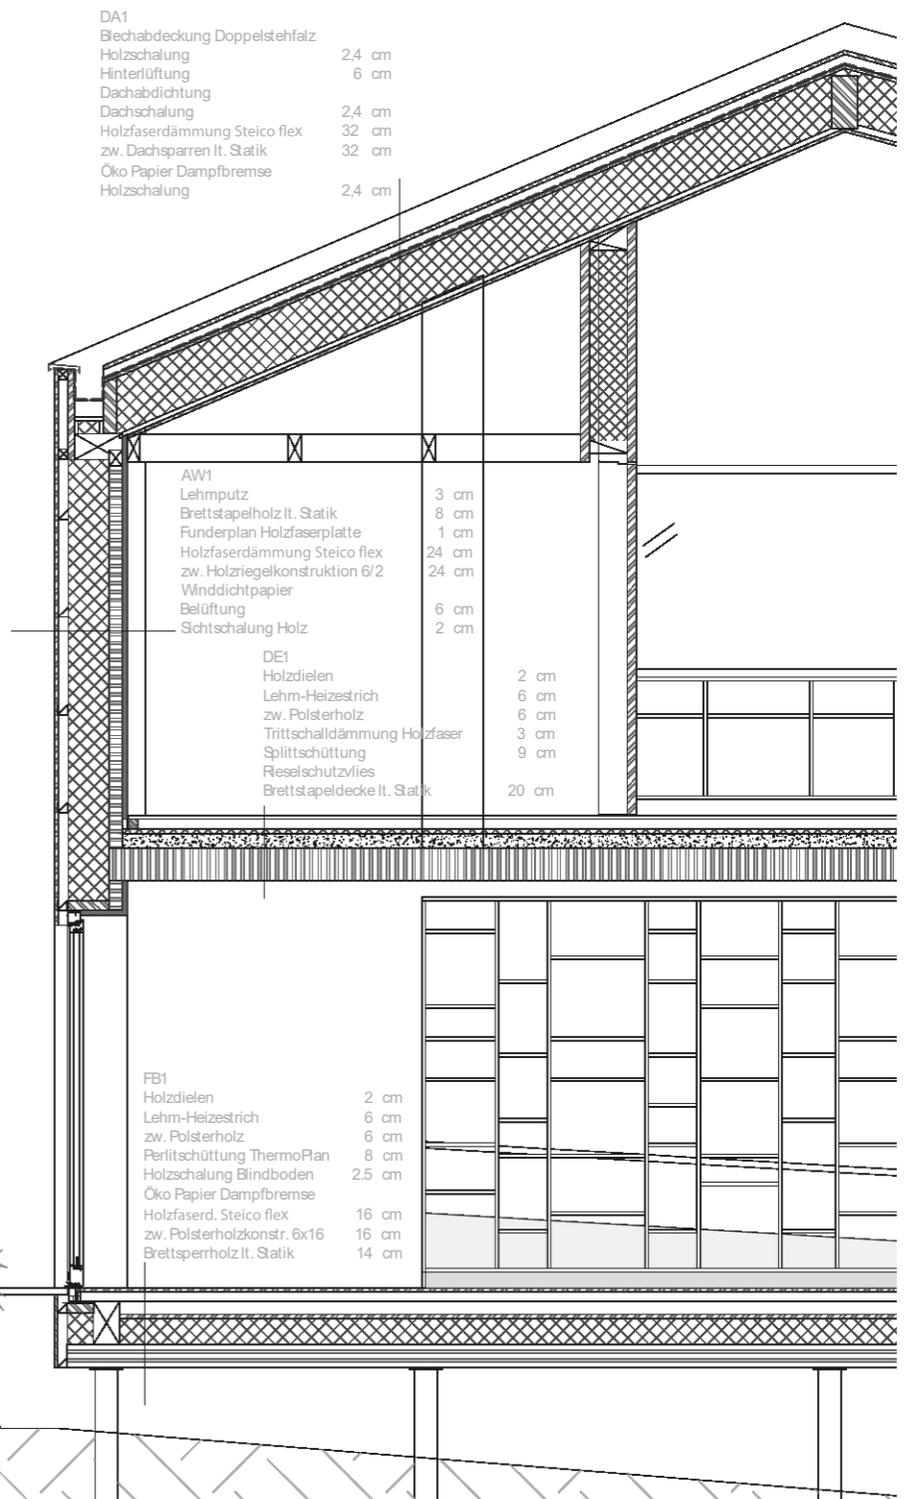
Haus ohne Beton, Fassadenschnitt B
